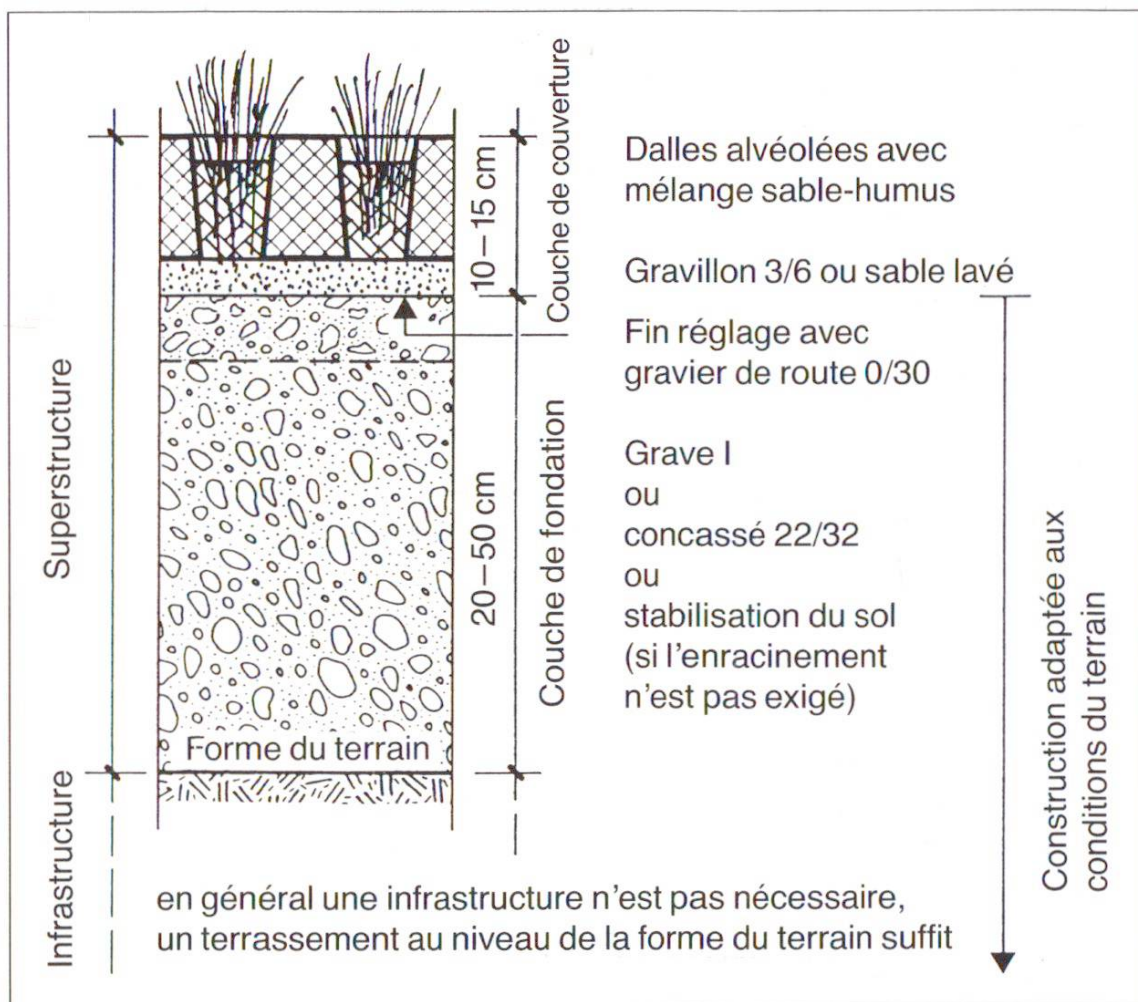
Construction d'une surface avec dalles alvéolées. Désignation selon SN 640 302 a).
